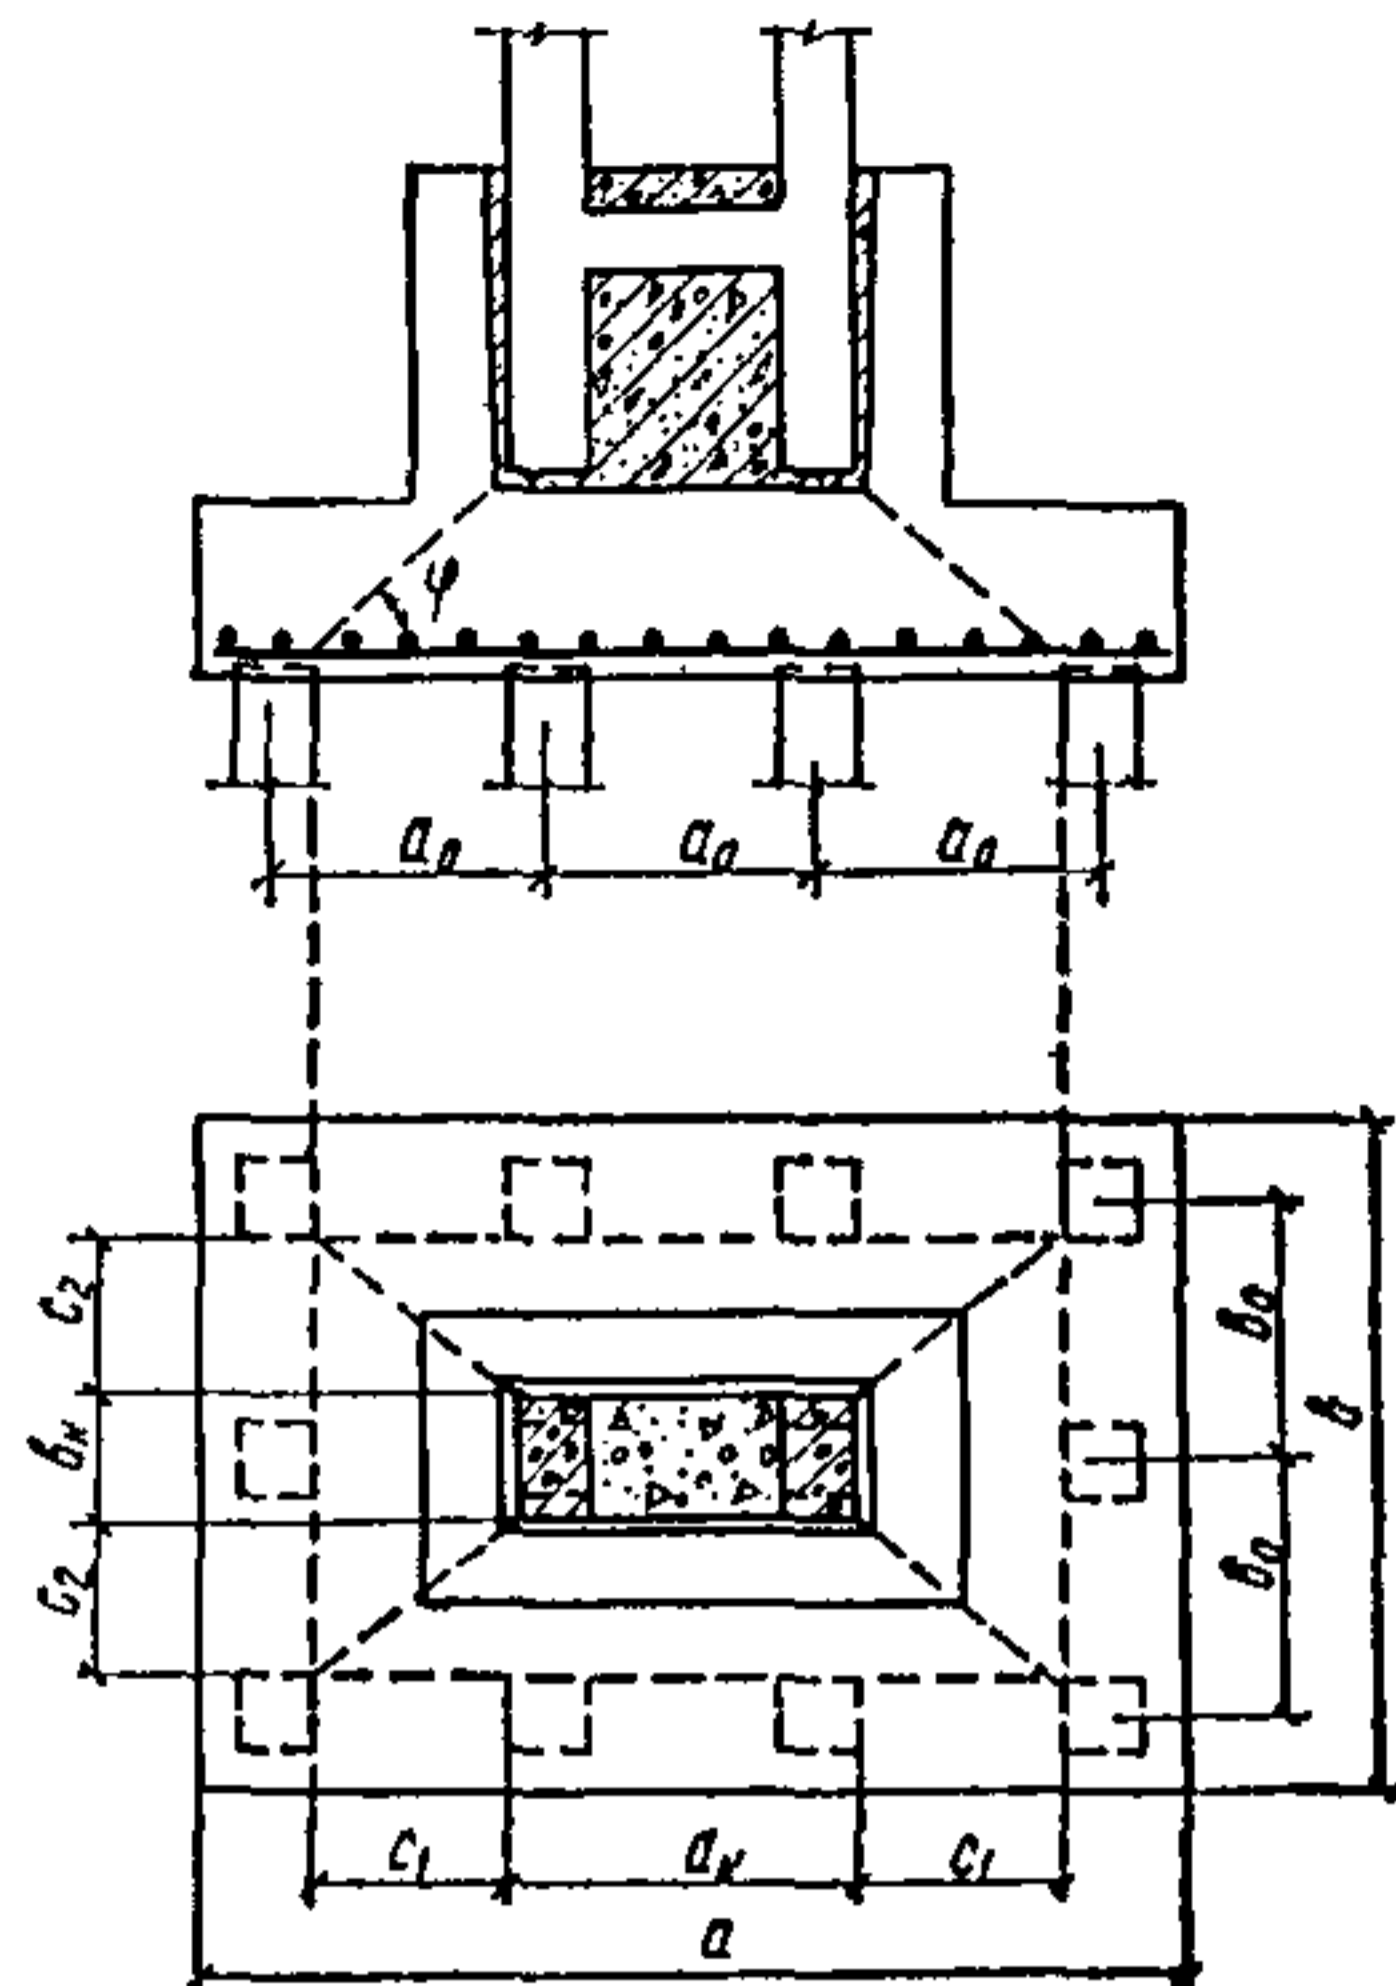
Схема образования пирамиды продавливания под сборной железобетонной двухветвевой колонной
